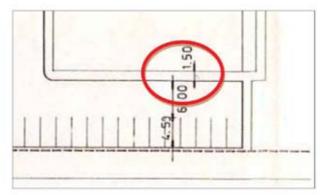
Extracto del plano del Proyecto de Dotación de Infraestructuras
